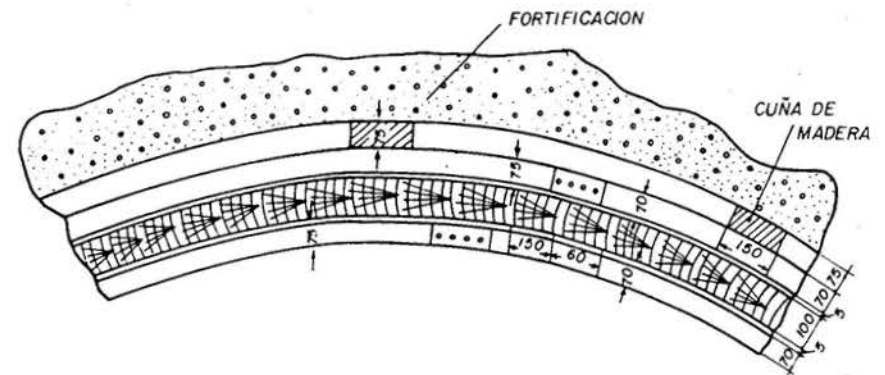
Detalles de la instalación del hincado vertical de madera.
